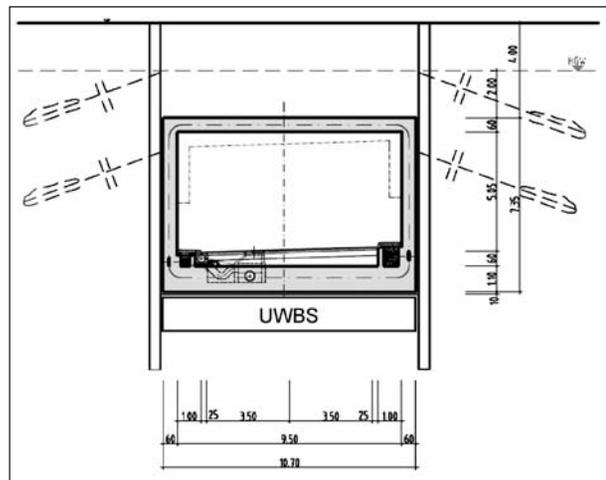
Beispiel eines typischen Regelquerschnittes eines Tunneln in offener Bauweise mit verankerten Baugrubwänden
